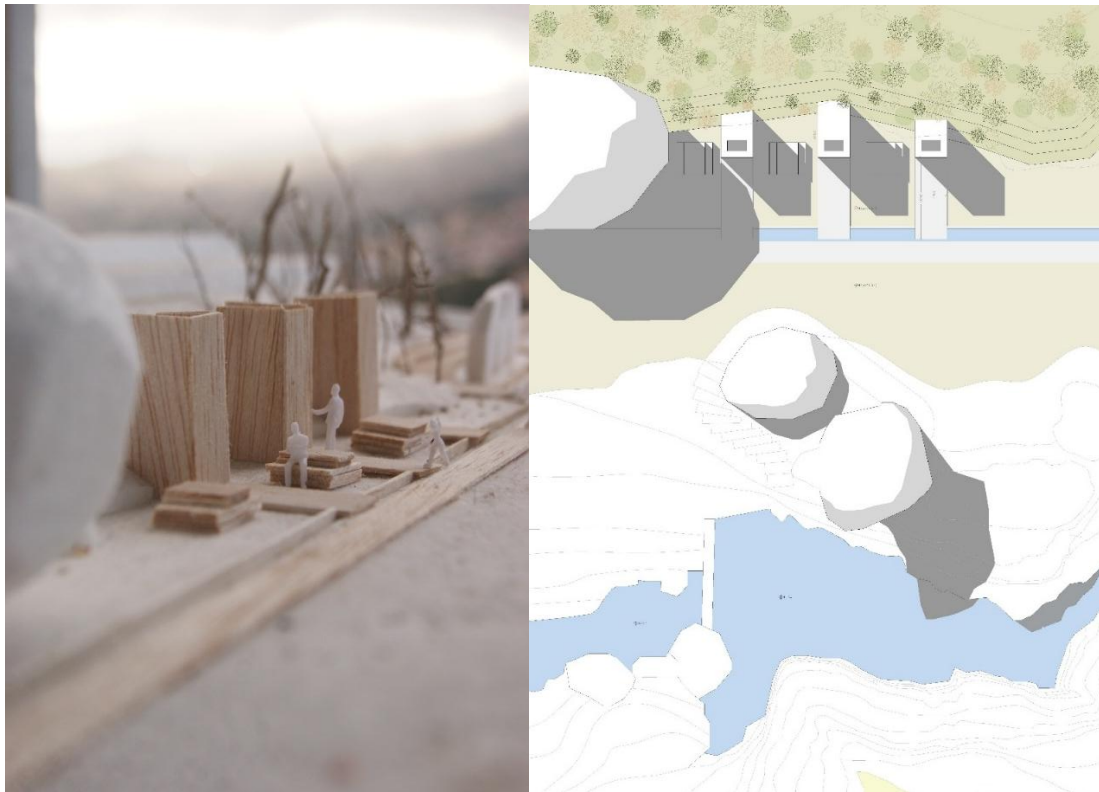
Maquete e planta de cobertura dos fogareiros. - Imagem de autor
